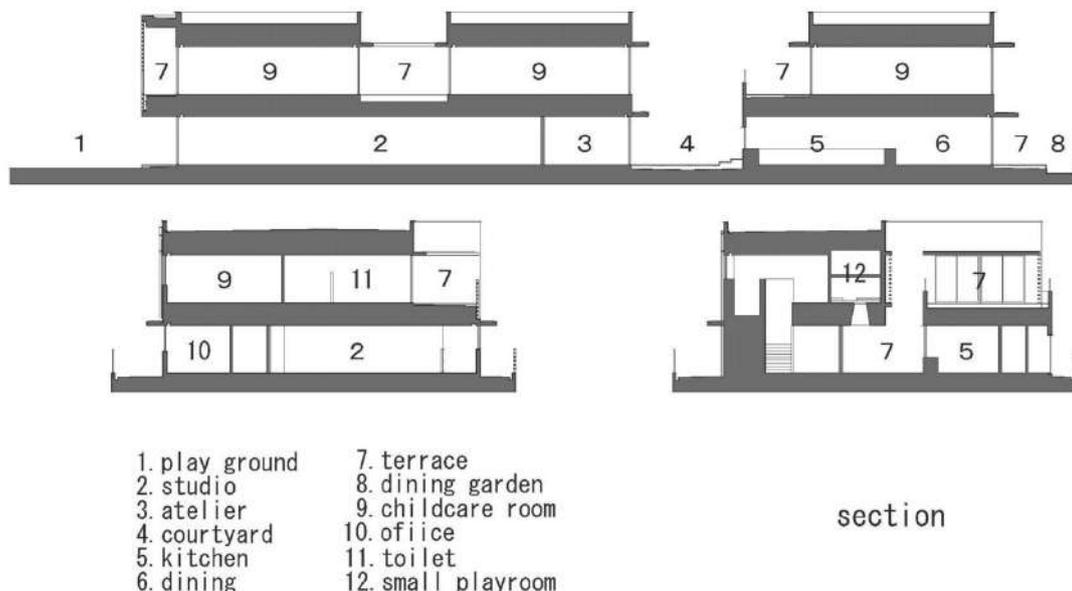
Plano de sección del proyecto Kindergarten y Guardería Hanazono. Fuente: Página Web Archdaily.
